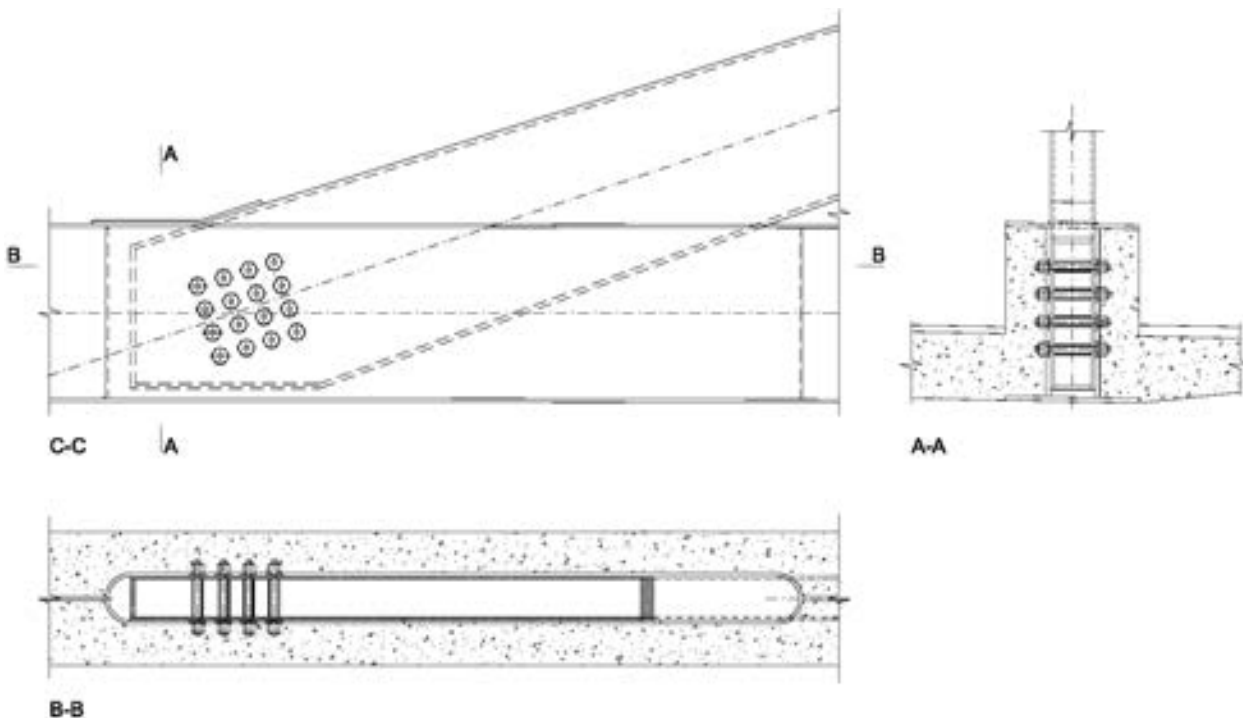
Unión del tirante rígido con la viga longitudinal del tablero
